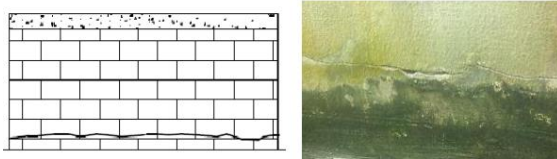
Fissuração horizontal na base da alvenaria por movimentações higroscópicas. [6]
